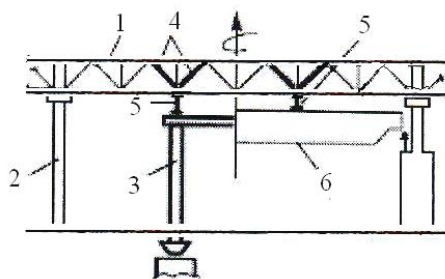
Усиление ферм способом установки дополнительных промежуточных опор:
